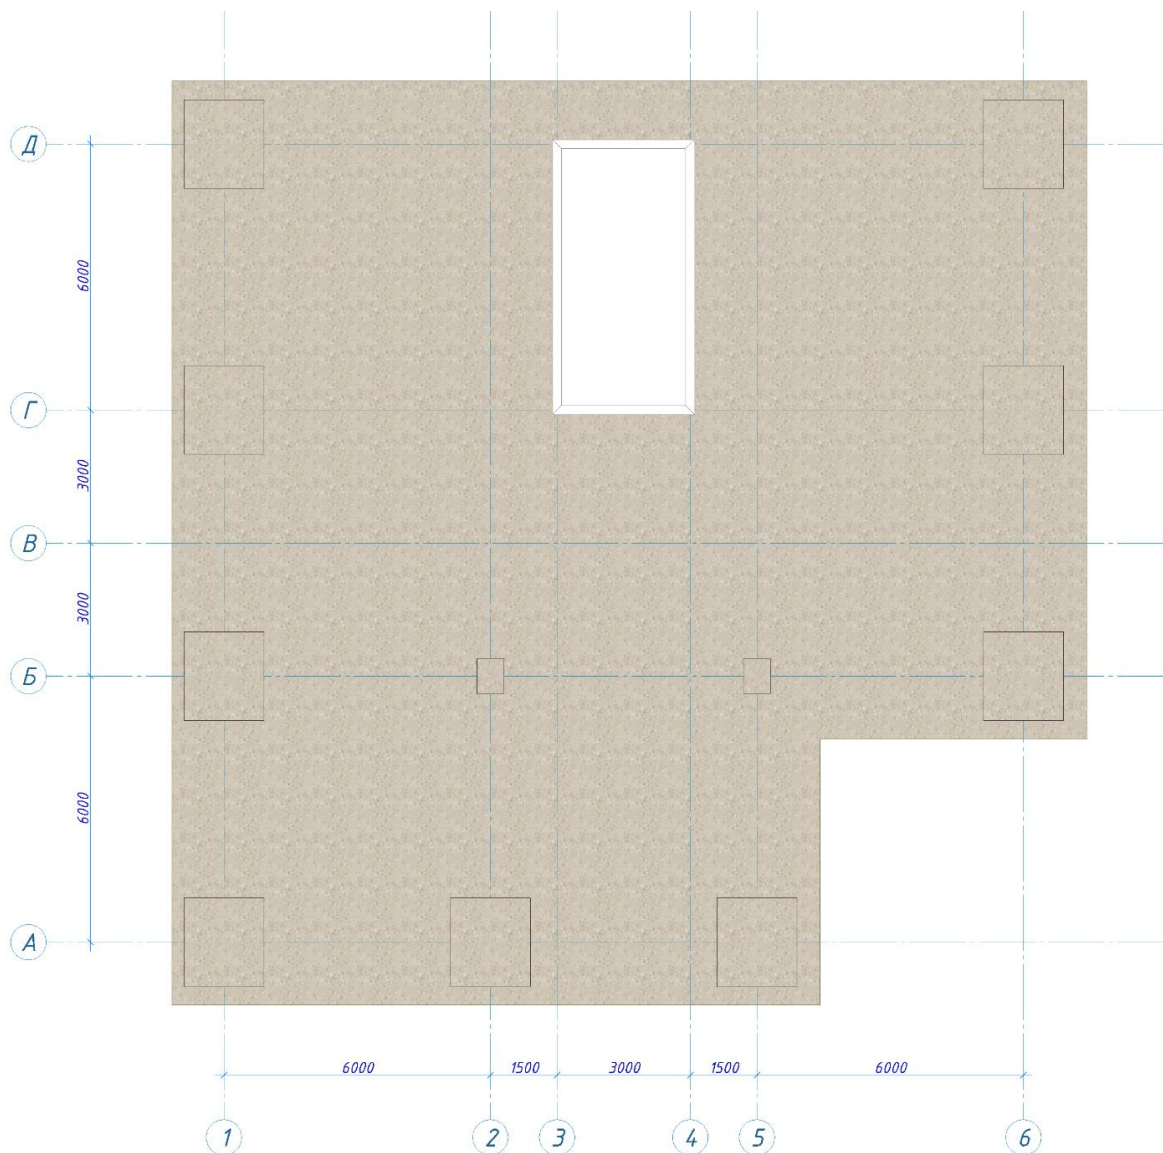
Розташування прорізу в плиті перекриття на виді зверху
